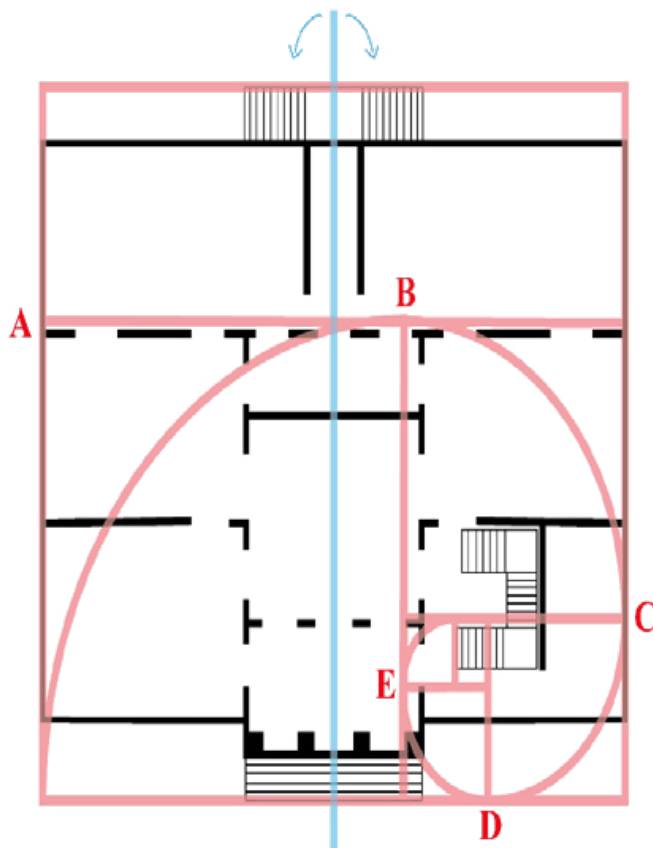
A proporção áurea aplicada sobre a planta baixa do solar. Fonte: elaborada pelos autores, 2019.
